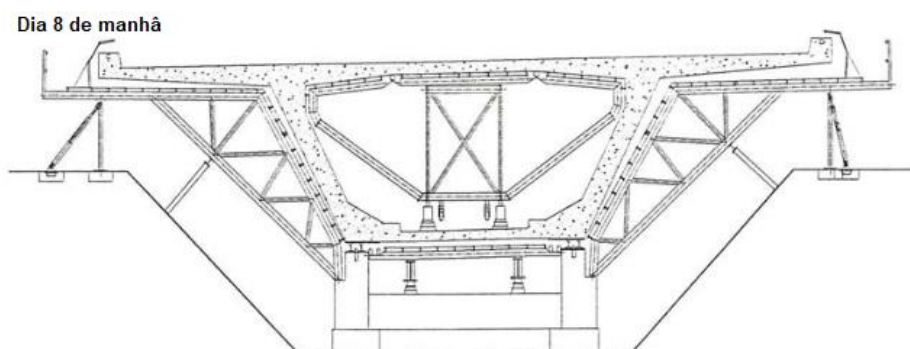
Processo construtivo da viga-caixão- Dia 8 de manhã
